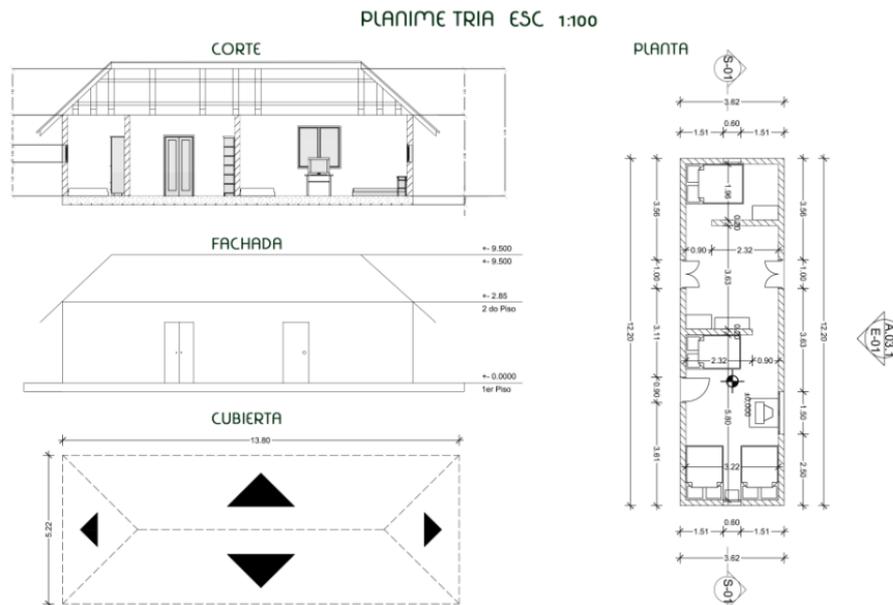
Planos de una de las tipologías de vivienda del Cairo las Brisas
